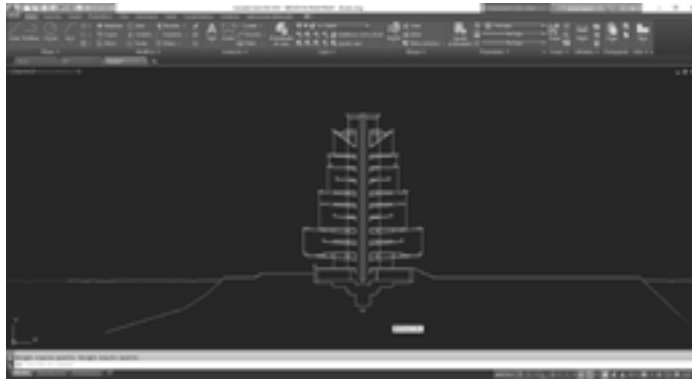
Espacio de trabajo AutoCAD, Modelizado 3D, carpintería. [Fuente: Autor]
